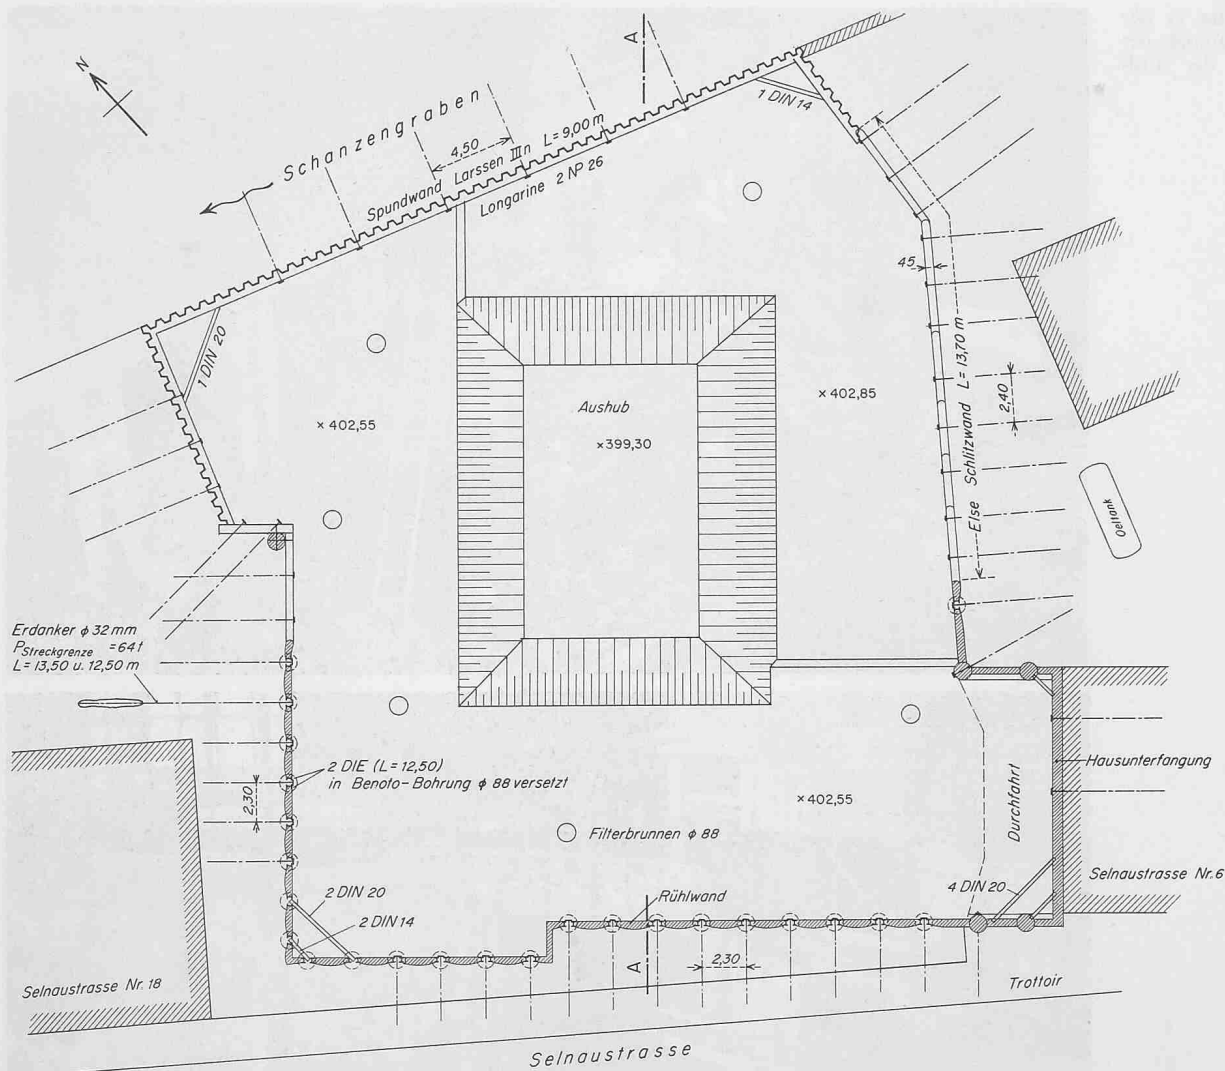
Baugrubenumschliessung, Grundriss 1:400
